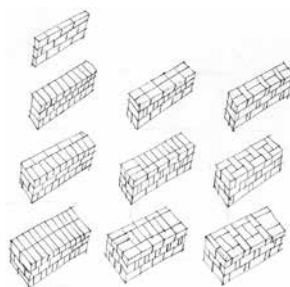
Sistema construtivo em alvenaria de tijolo_ Montagem da parede (Carvalho 2006)
